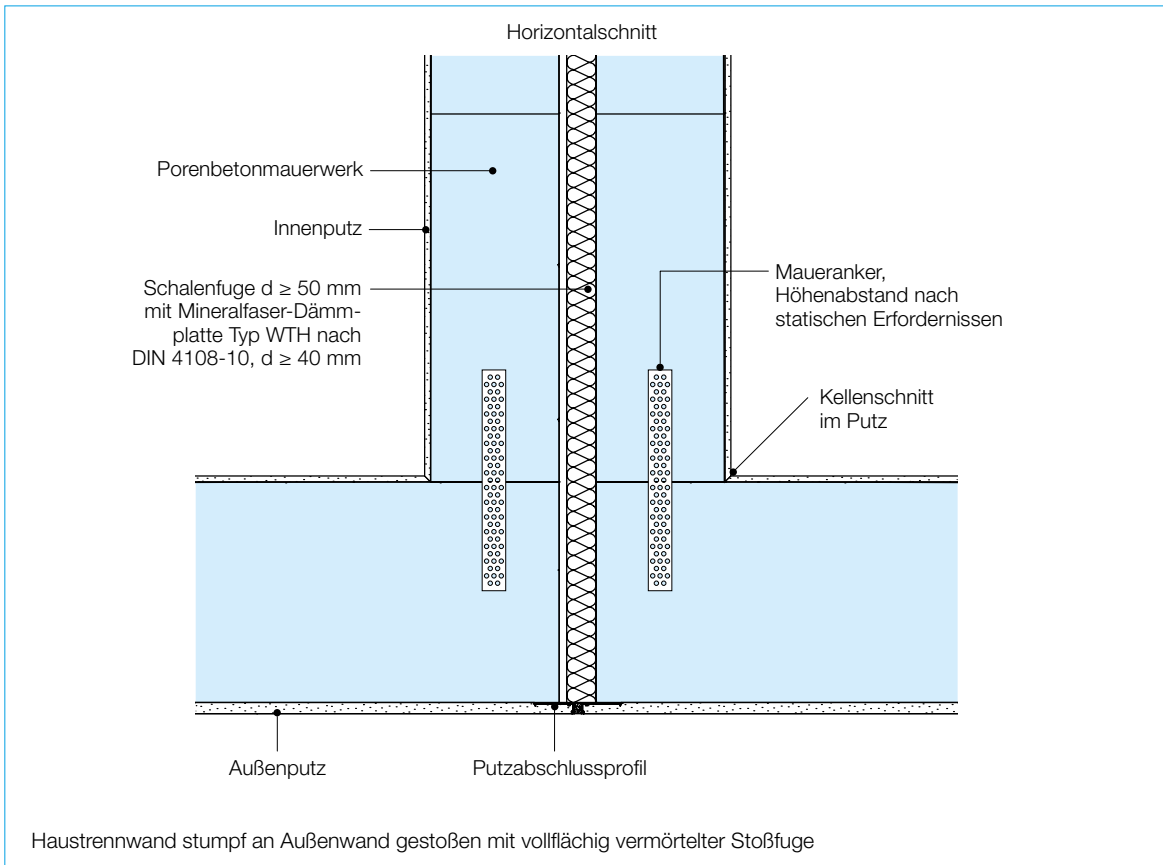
Seitlicher Anschluss einer zweischaligen Haustrennwand aus Porenbetonmauerwerk an eine Außenwand (mit Putzabschlussprofil)
